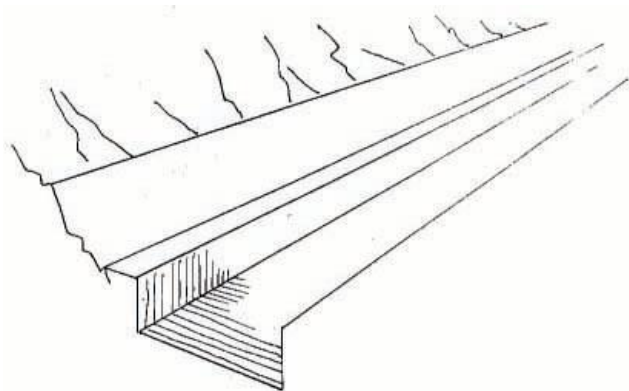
Preparación de la base y apertura de la zanja para la primera línea de bloques.
